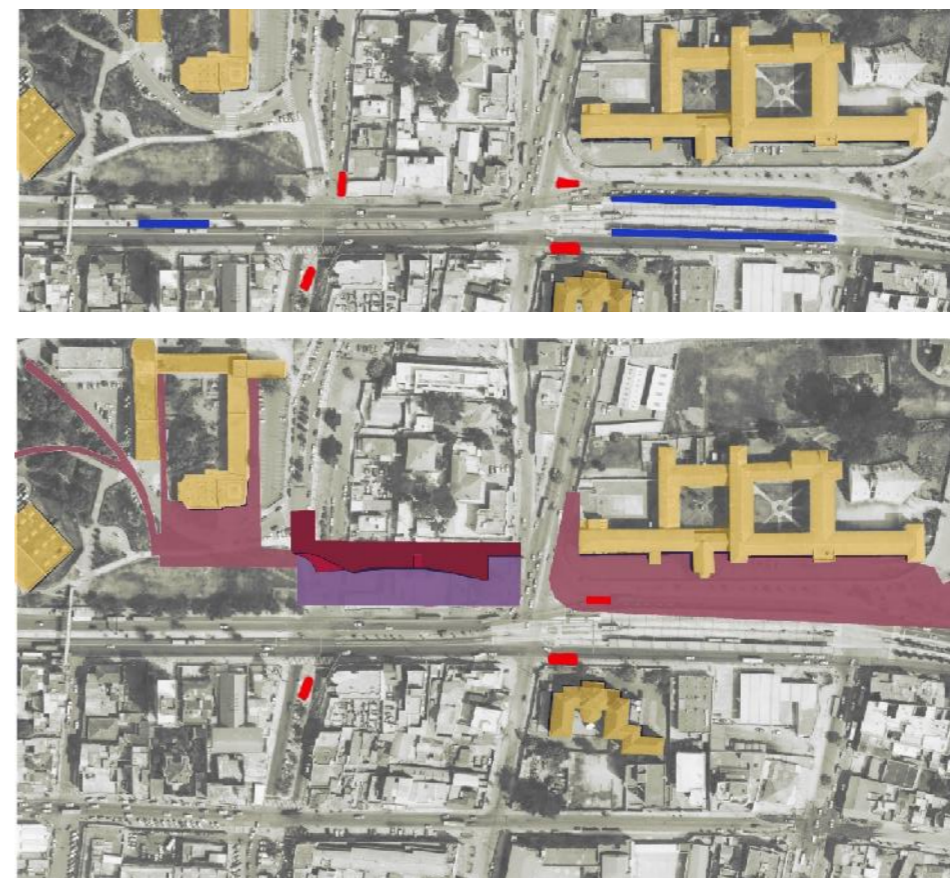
Planta de la actuación propuesta de la planta existente con las paradas de autobús y las propuestas de salida de metro diseñadas por Metroquito y la planta propuesta por nuestro equipo con las tres plazas y los edificios más significativos. Fuente: Google Maps, Elaboración Propia.
